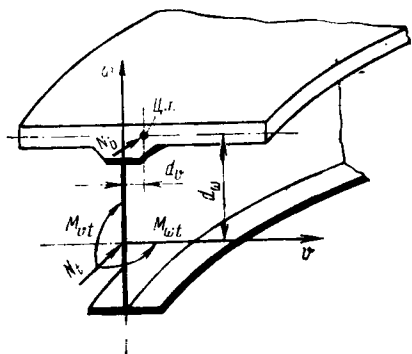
Схема для расчета сталежелезобетонных балок пролетных строений с открытым контуром поперечного сечения с учетом длительных деформаций:
